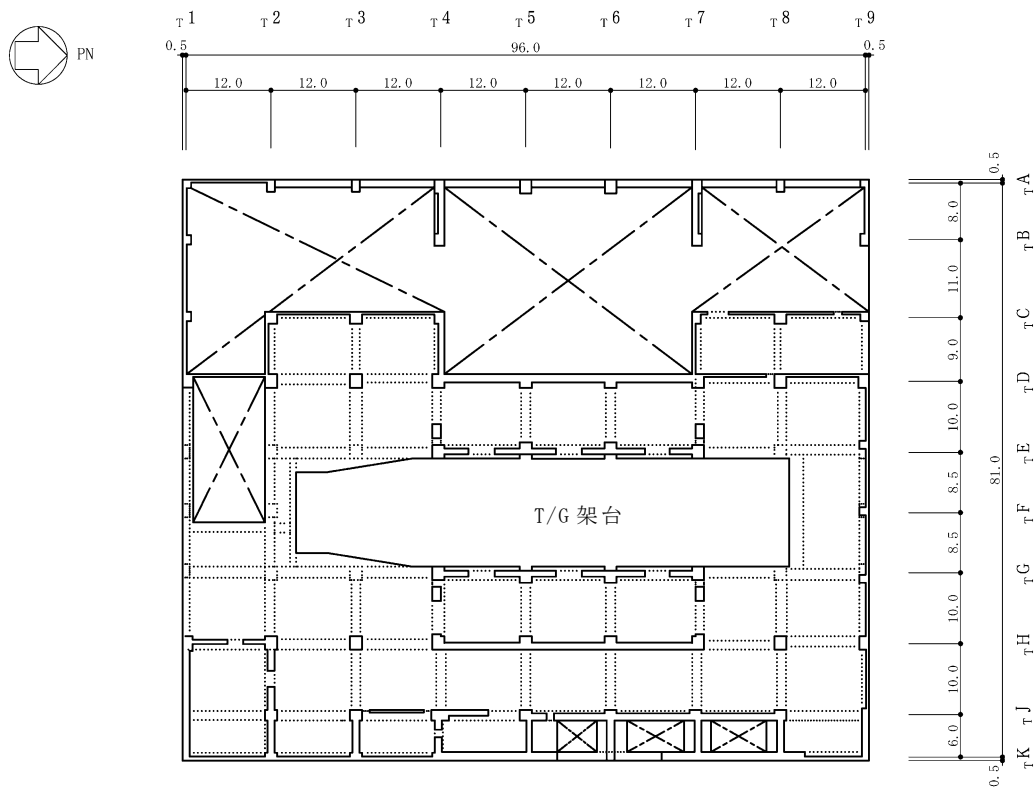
タービン建屋の概略平面図 (2F, T. M. S. L. 20.4m) (4/6) (単位 : m)
